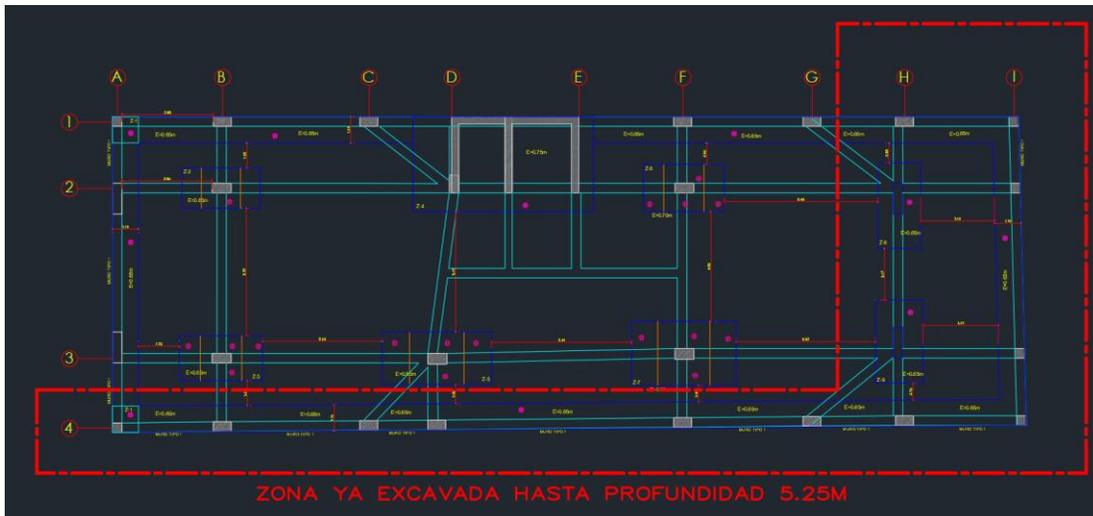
Planta de cimentación (fuente: planos estructurales Edificio Fourvière)
